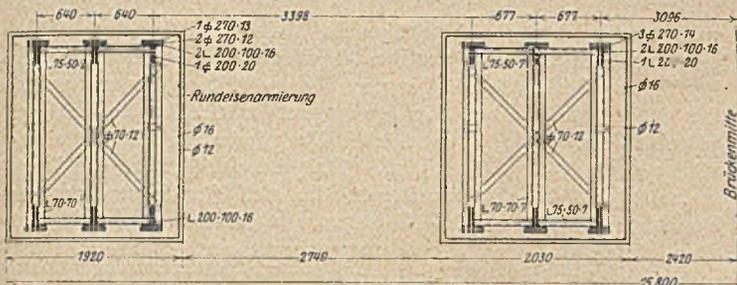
Entwurf Elbbrücke Dresden. Querschnitt bb der Bogenrippen mit Einzelheiten der Bewehrung.
